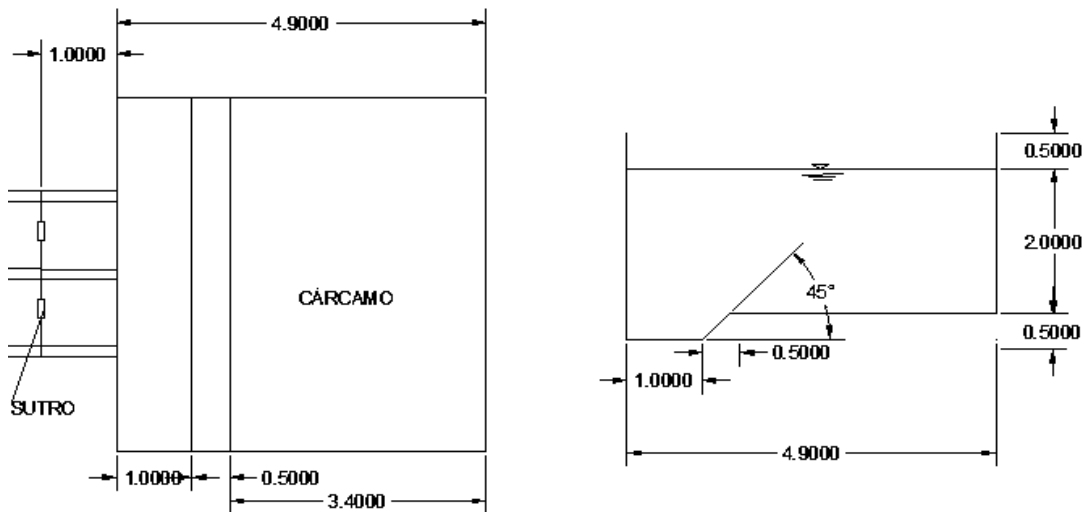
vista en planta y corte longitudinal del cárcamo de bombeo.
